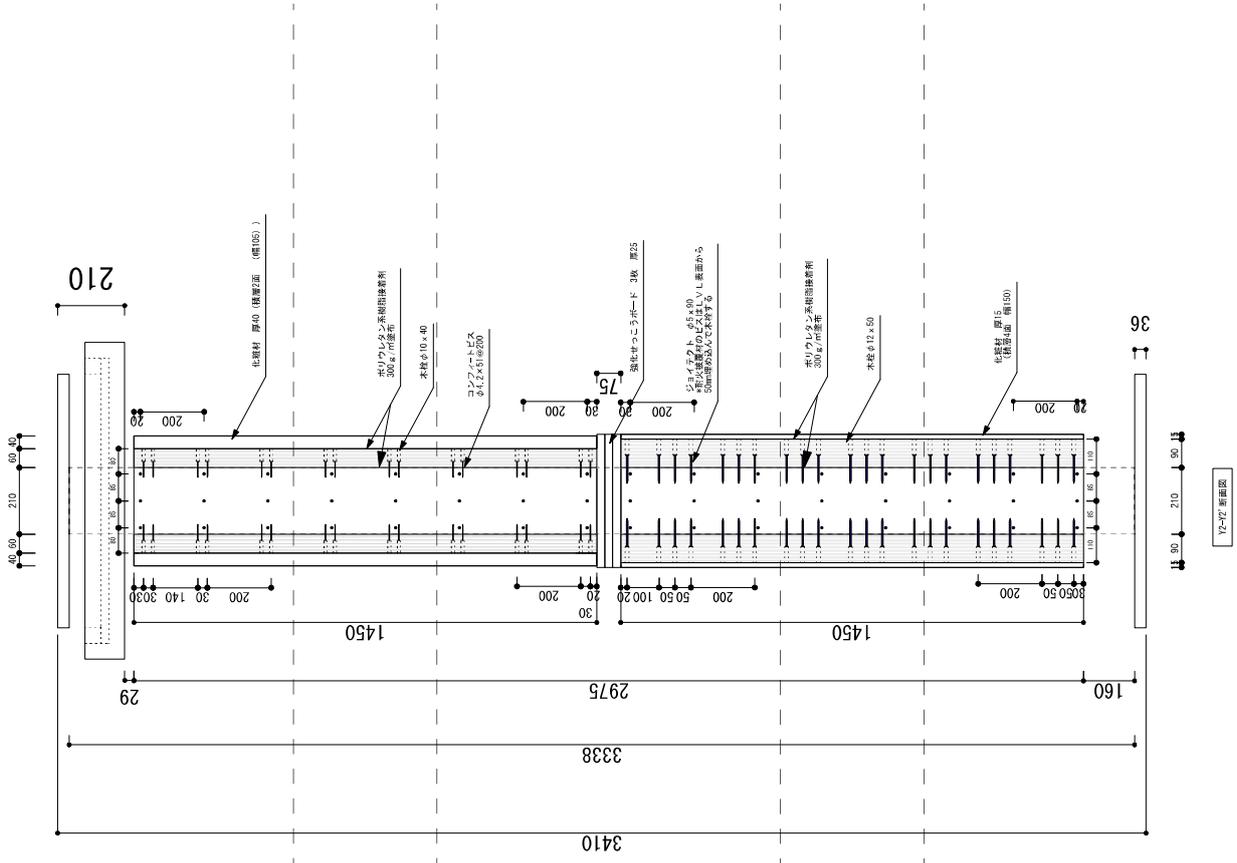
試験体Aの構造・寸法・各種測定位置 (寸法単位: mm)
